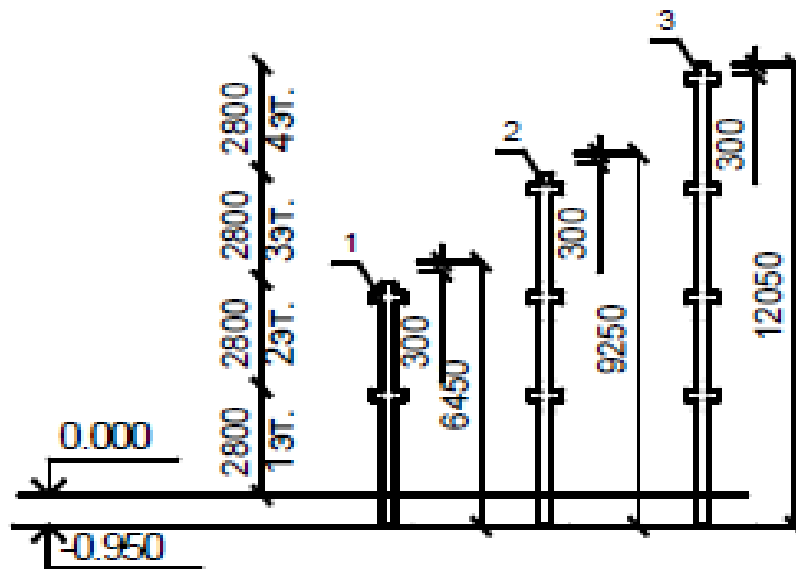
Колонны каркаса сечением 300х300 мм для зданий без подвала с высотой этажей 2800 мм
